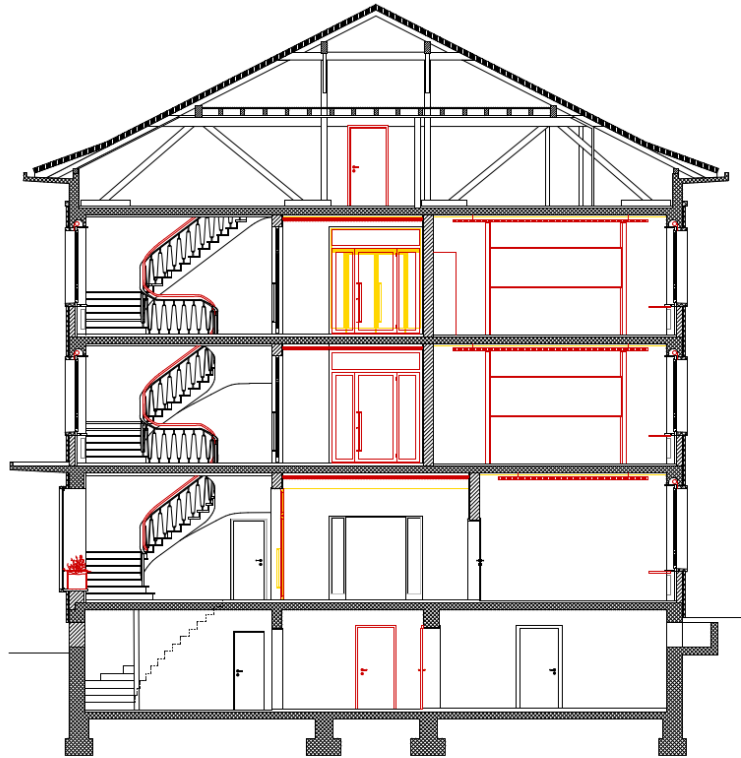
Grundriss DachgeschossAbbildung 6: Grundriss Längsschnitt
